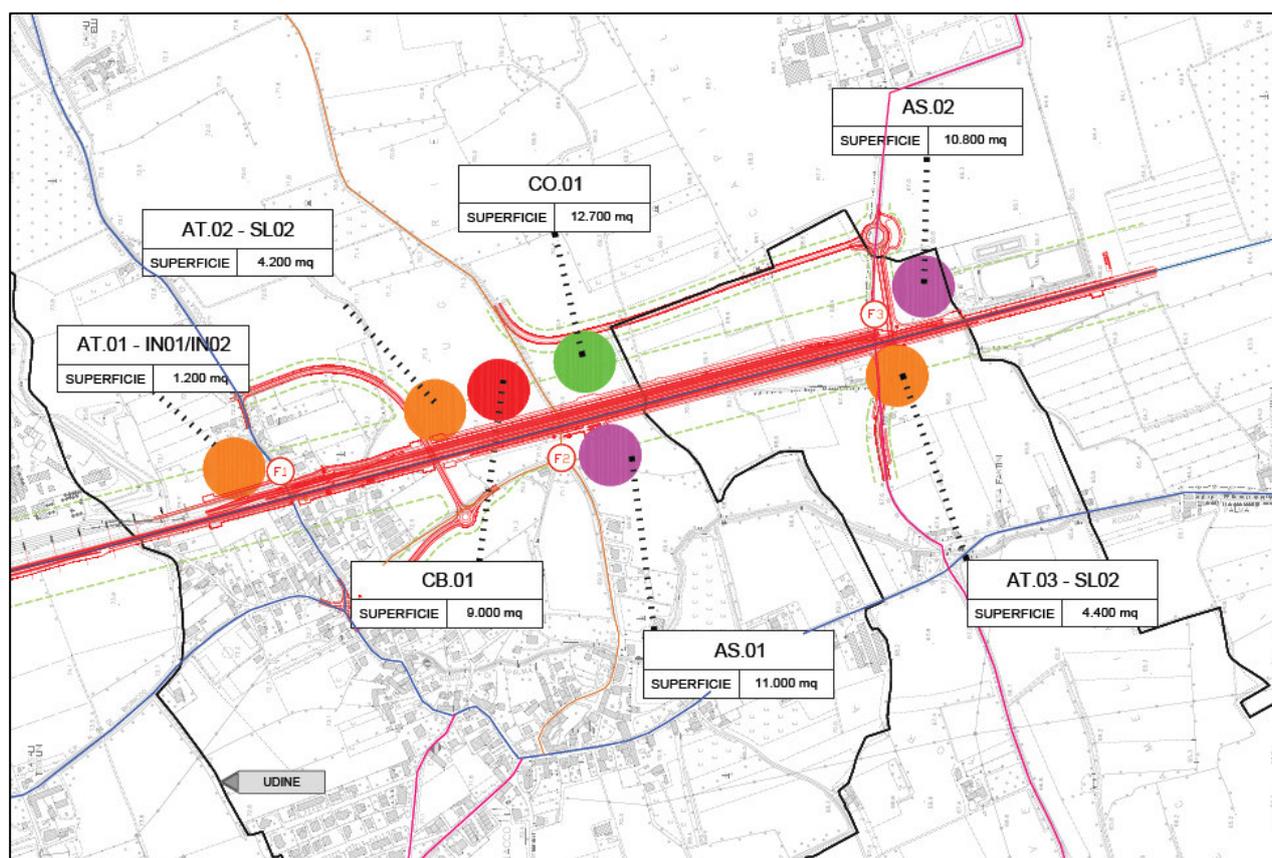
Aree di cantiere e viabilità di accesso 1/2
